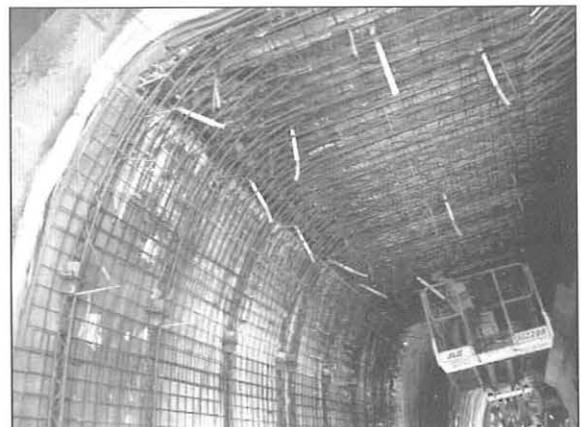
"Flat roof section" - Sonderprofil mit flacher Kalotte am Tunnelanfang
